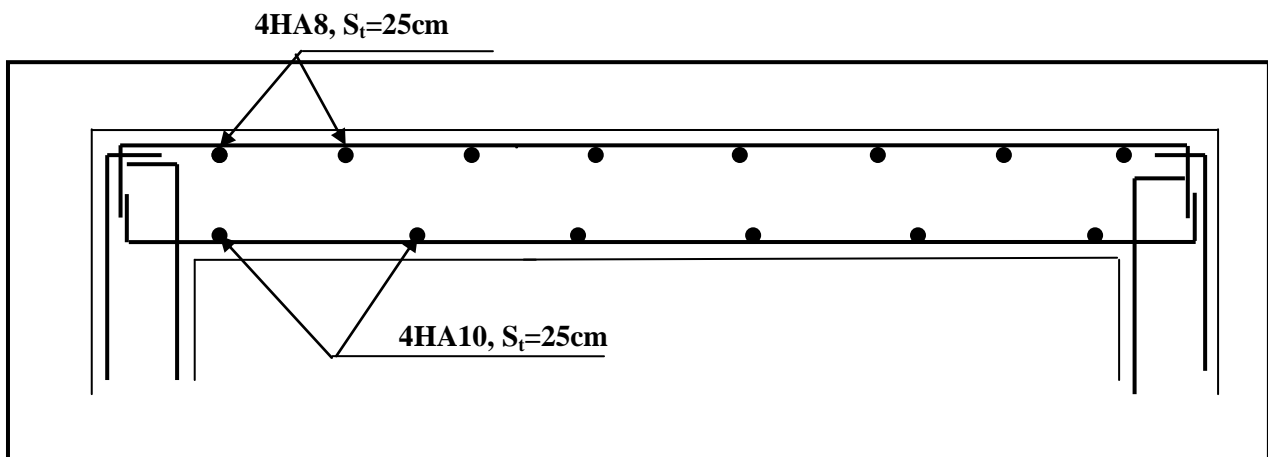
Plan de ferrailage de la salle machine suivant y-y
